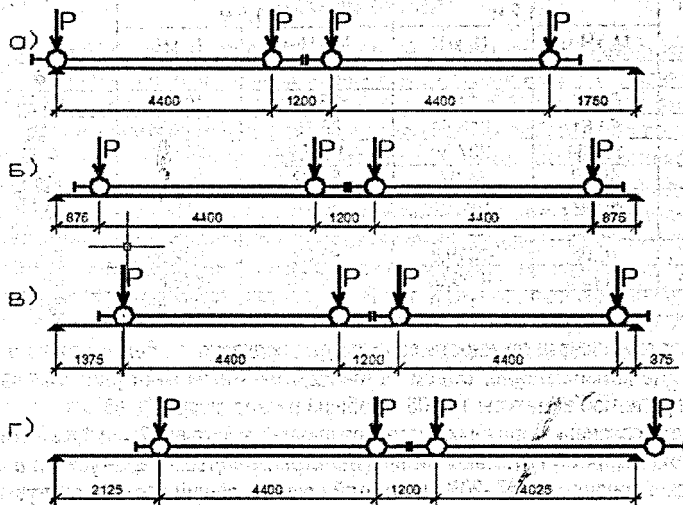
Схемы загрузки вертикальной нагрузкой
